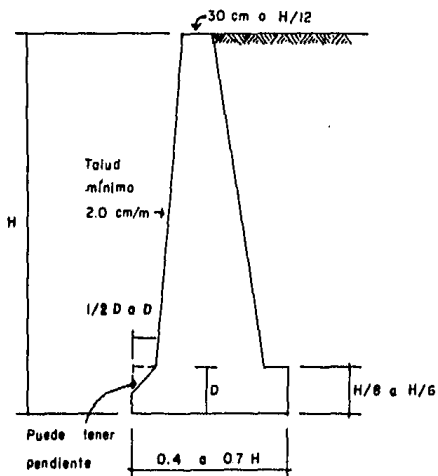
Dimensiones recomendables para un muro de gravedad
